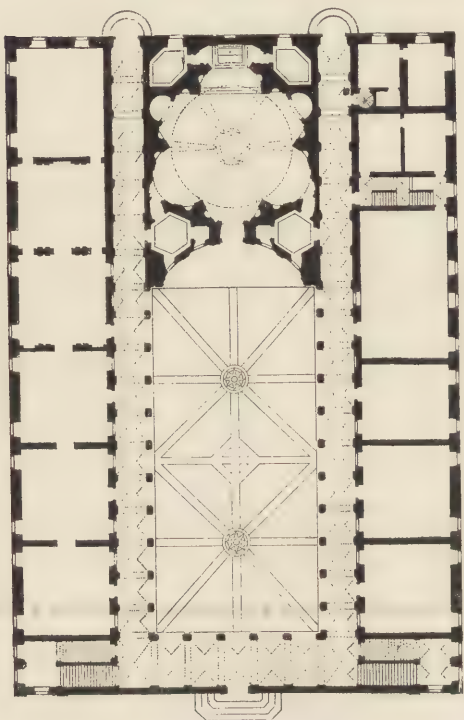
Sapienza zu Rom. Grundriss. (Nach Gurlitt.)
